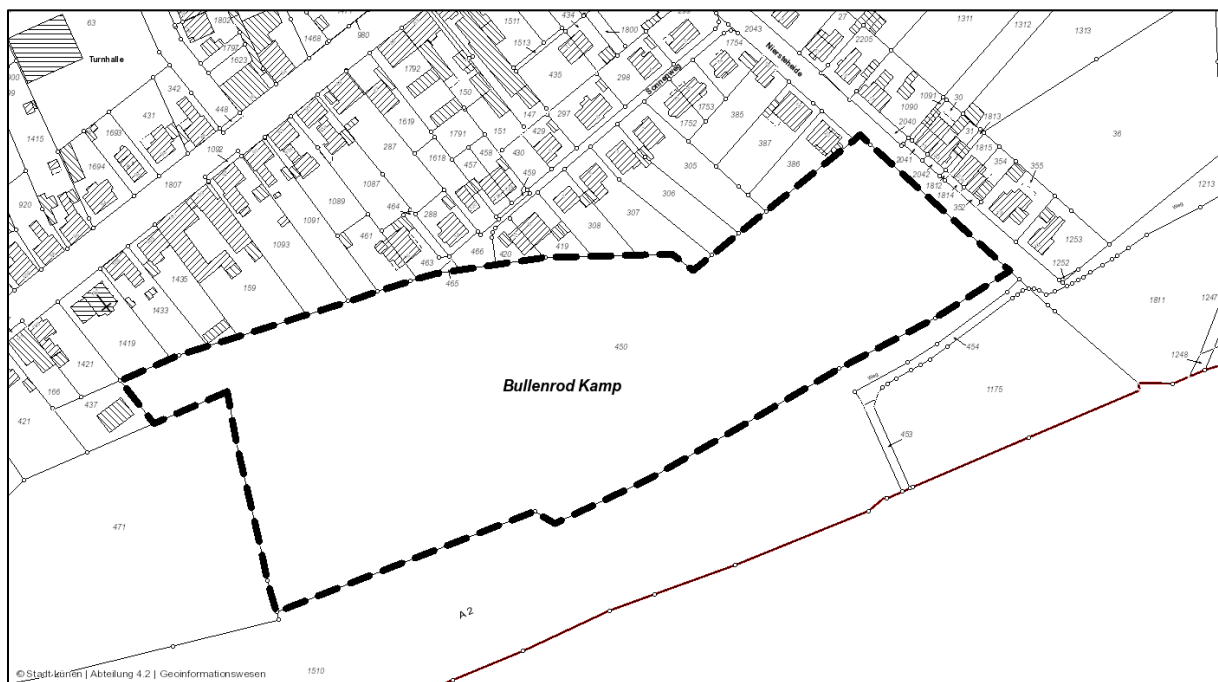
Lageplan mit Plangebietsabgrenzung
